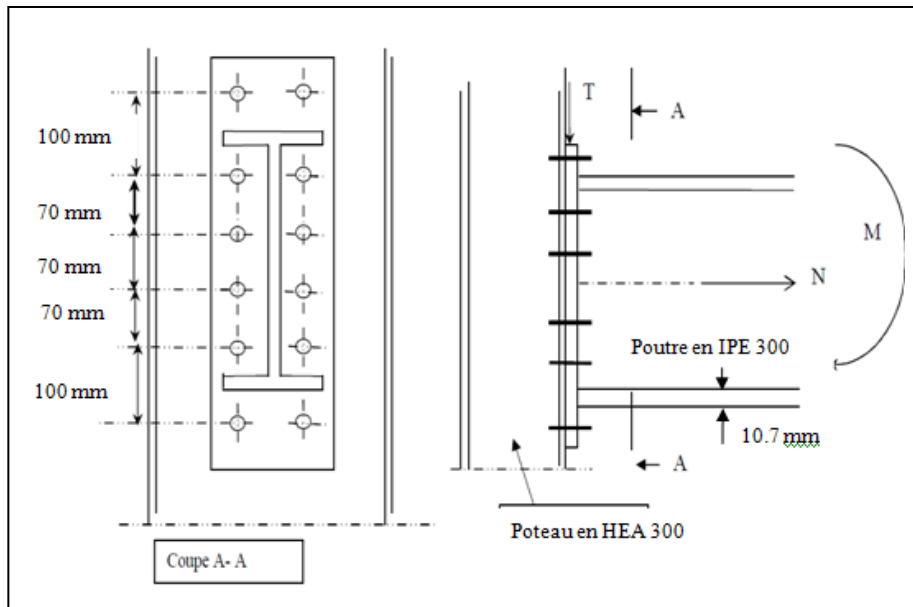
détail d'un assemblage d'une poutre avec un poteau
